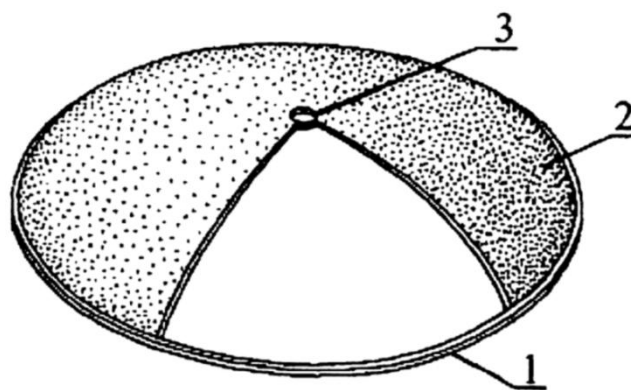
Конструктивная схема купола: 1-нижнее опорное кольцо; 2-оболочка; 3-верхнее опорное кольцо
